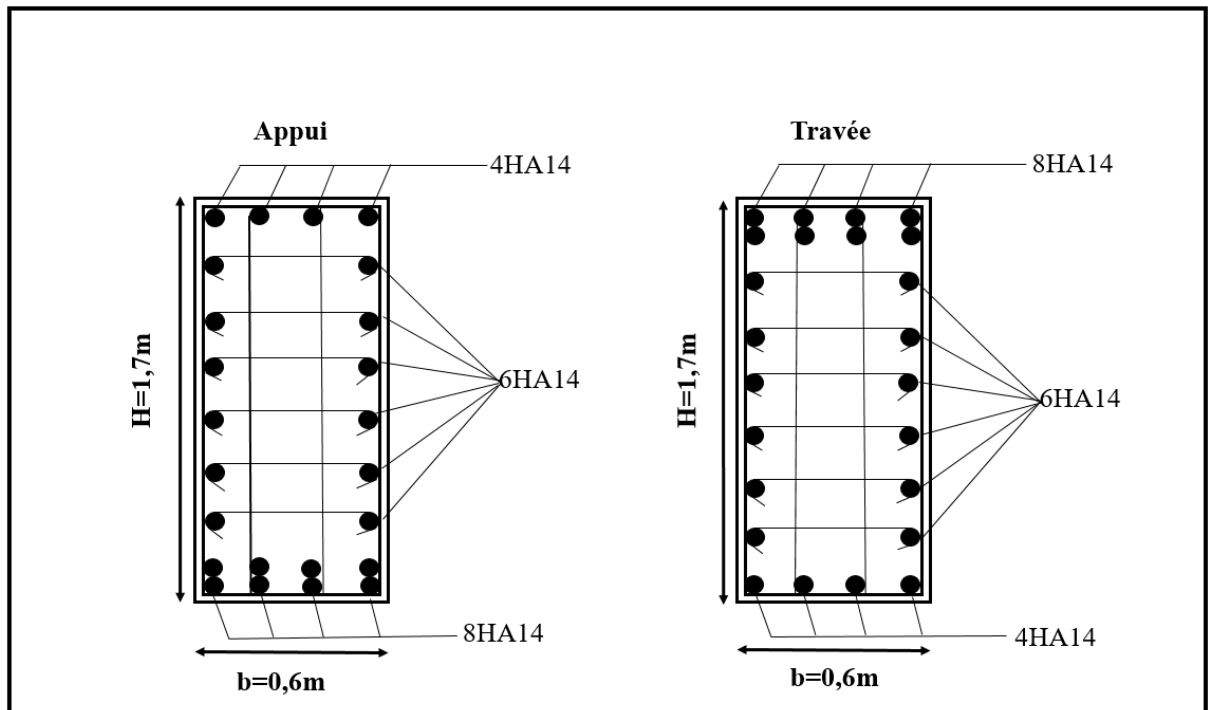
Ferrailage de la nervure de 1,7 m.
